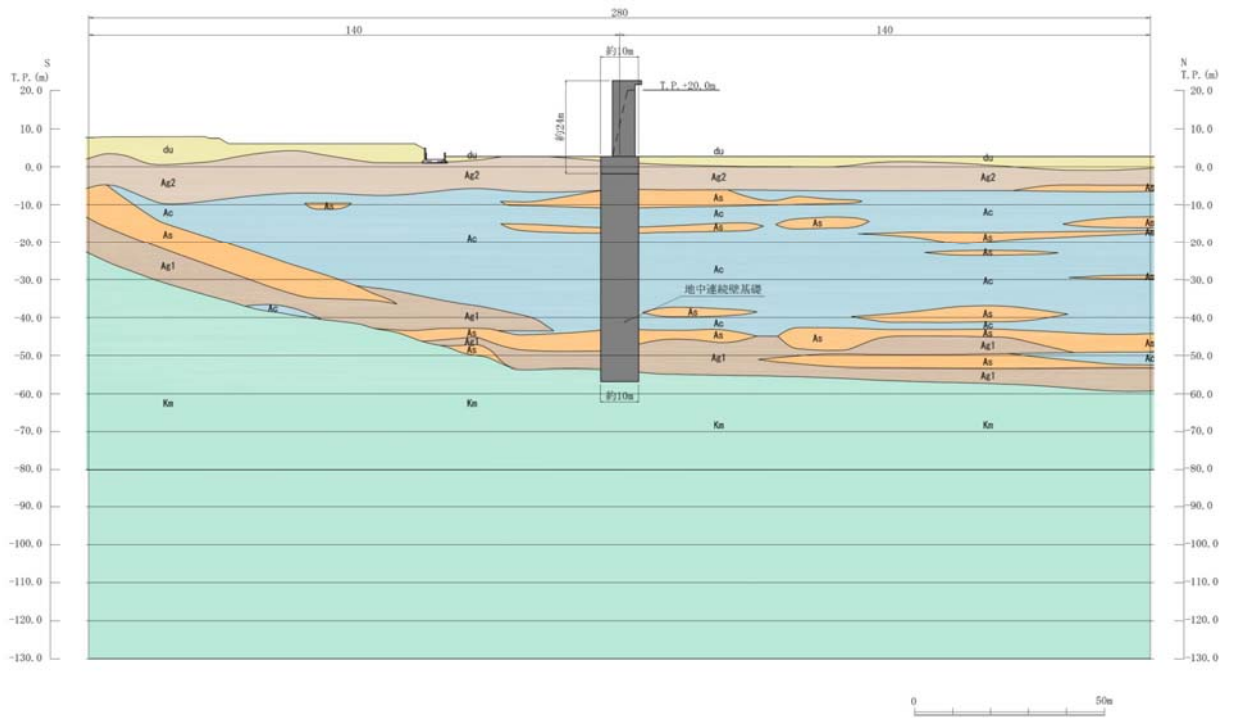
(1) 鉄筋コンクリート防潮壁 評価対象断面図 (①-①断面)
